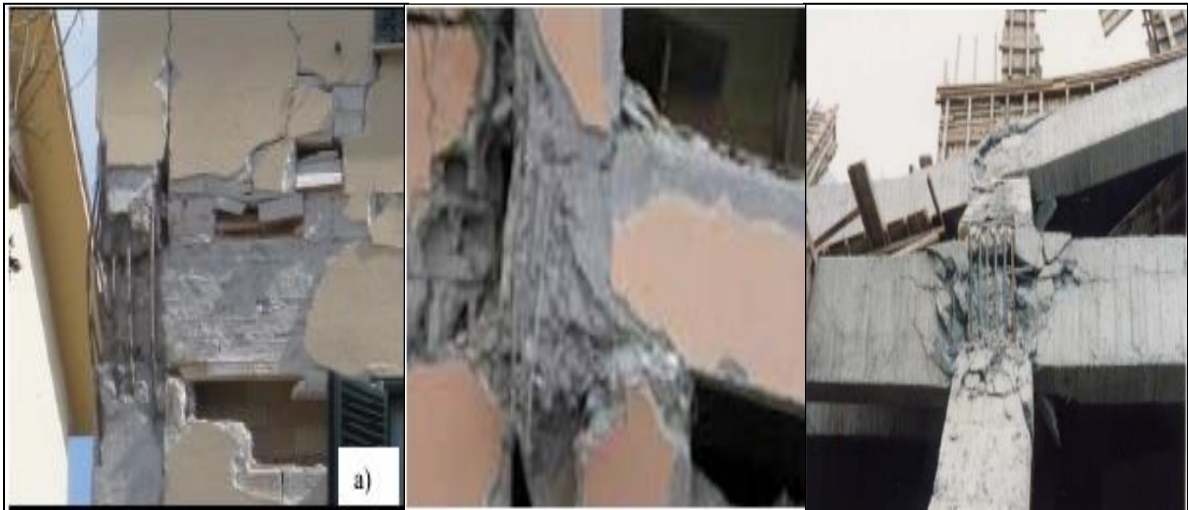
Kegagalan pada sambungan tulangan kolom tidak terdapat sengkang sehingga sambungan tulangan ⁽¹⁷⁾
